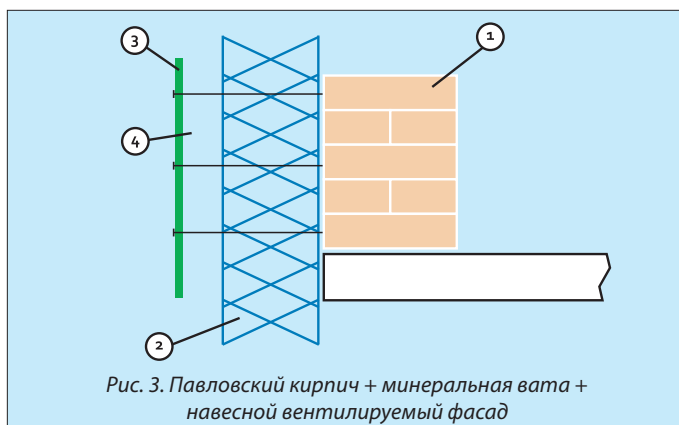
Павловский кирпич + минеральная вата + навесной вентилируемый фасад
